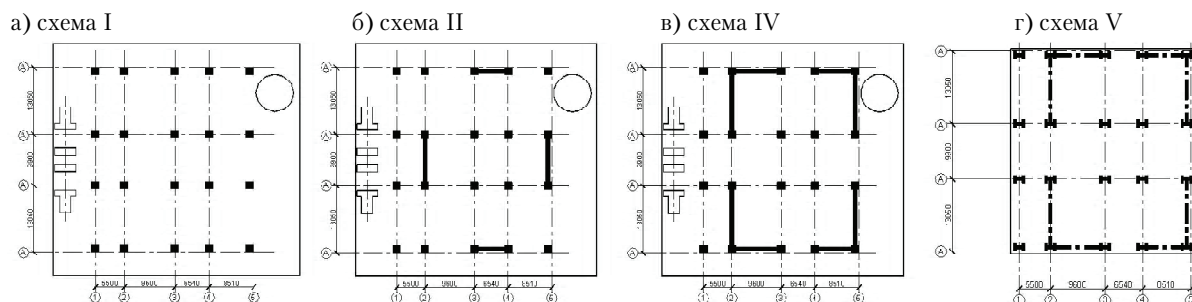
Схемы этажек в плане: а) без диафрагм жесткости; б) диафрагмы по торцам в центре; в) диафрагмы по углам; г) металлический связевой каркас с жесткими узлами.
